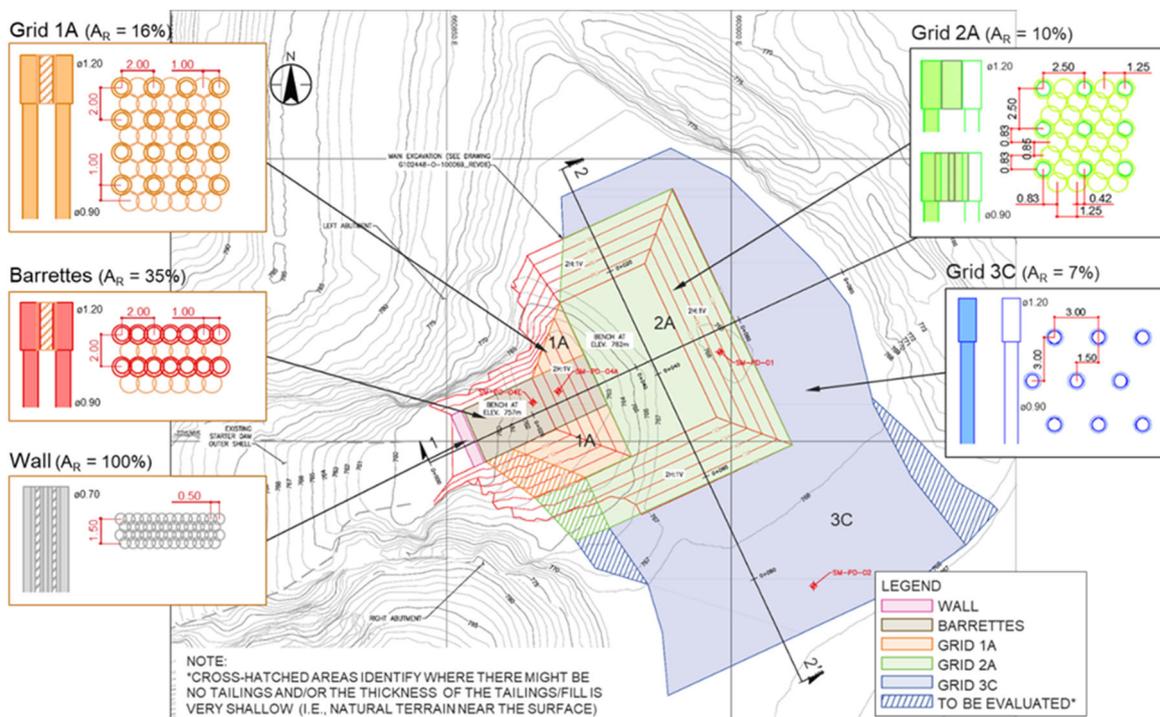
Elementos da solução em Jet Grouting (PINHEIRO et al., 2023).
